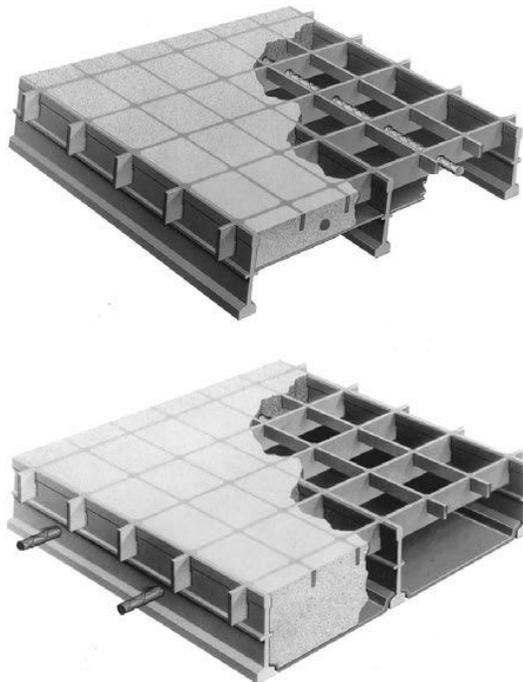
Esquema de una cubierta de parrilla de acero rellena con concreto (Chen y Duan, 2003)
